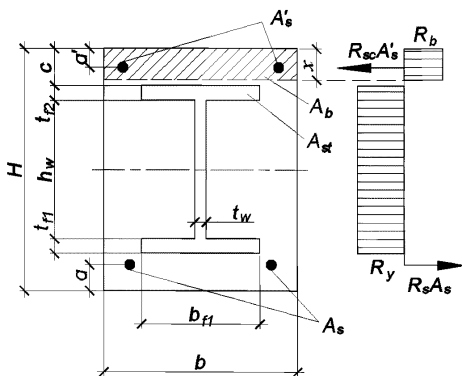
Случай, когда нейтральная ось не пересекает профиль жесткой арматуры и находится ниже верхней гибкой арматуры в обетонированной балке прямоугольного сечения
